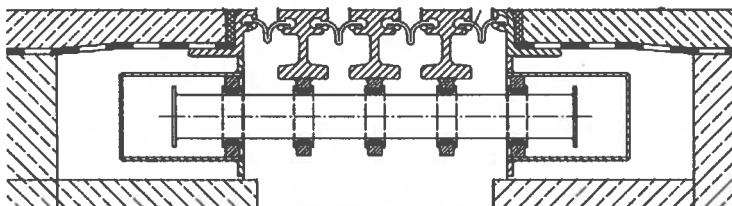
Secțiune transversală rost de dilatație modular cu traversă, pentru suprafața pietonală. Figura prezintă dispunerea traversei pentru ghidaj.
